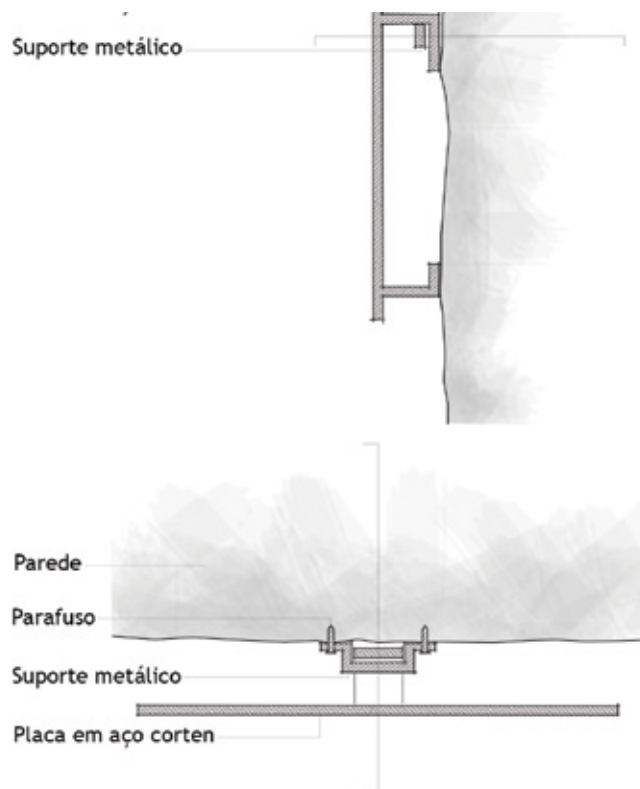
Sistema de fixação das placas, em corte e planta (sem escala)
